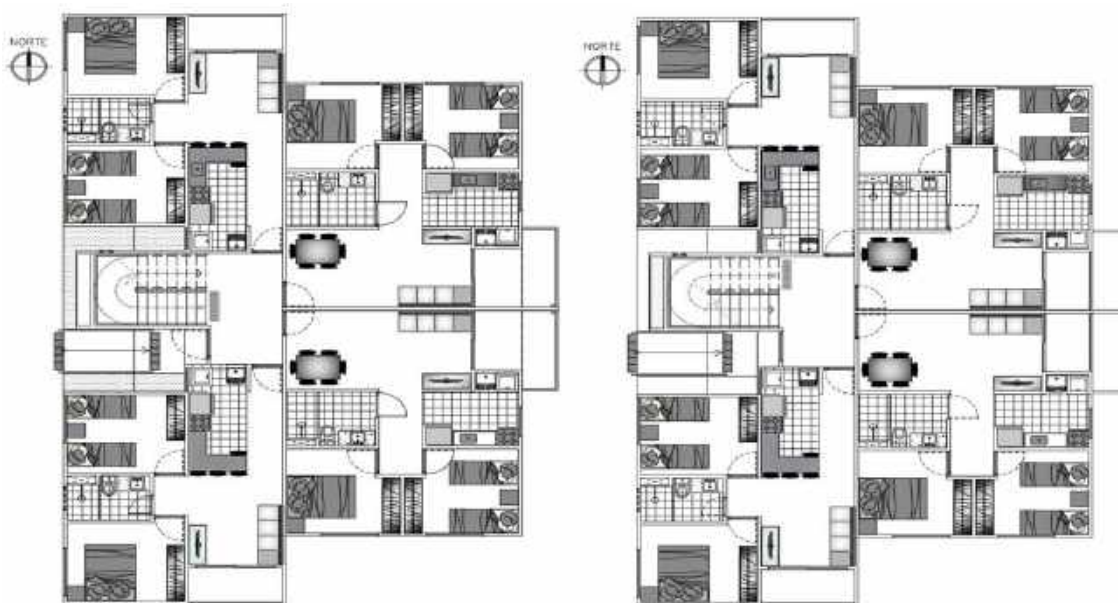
Planta Baixa do empreendimento (AUTOR, 2019).
